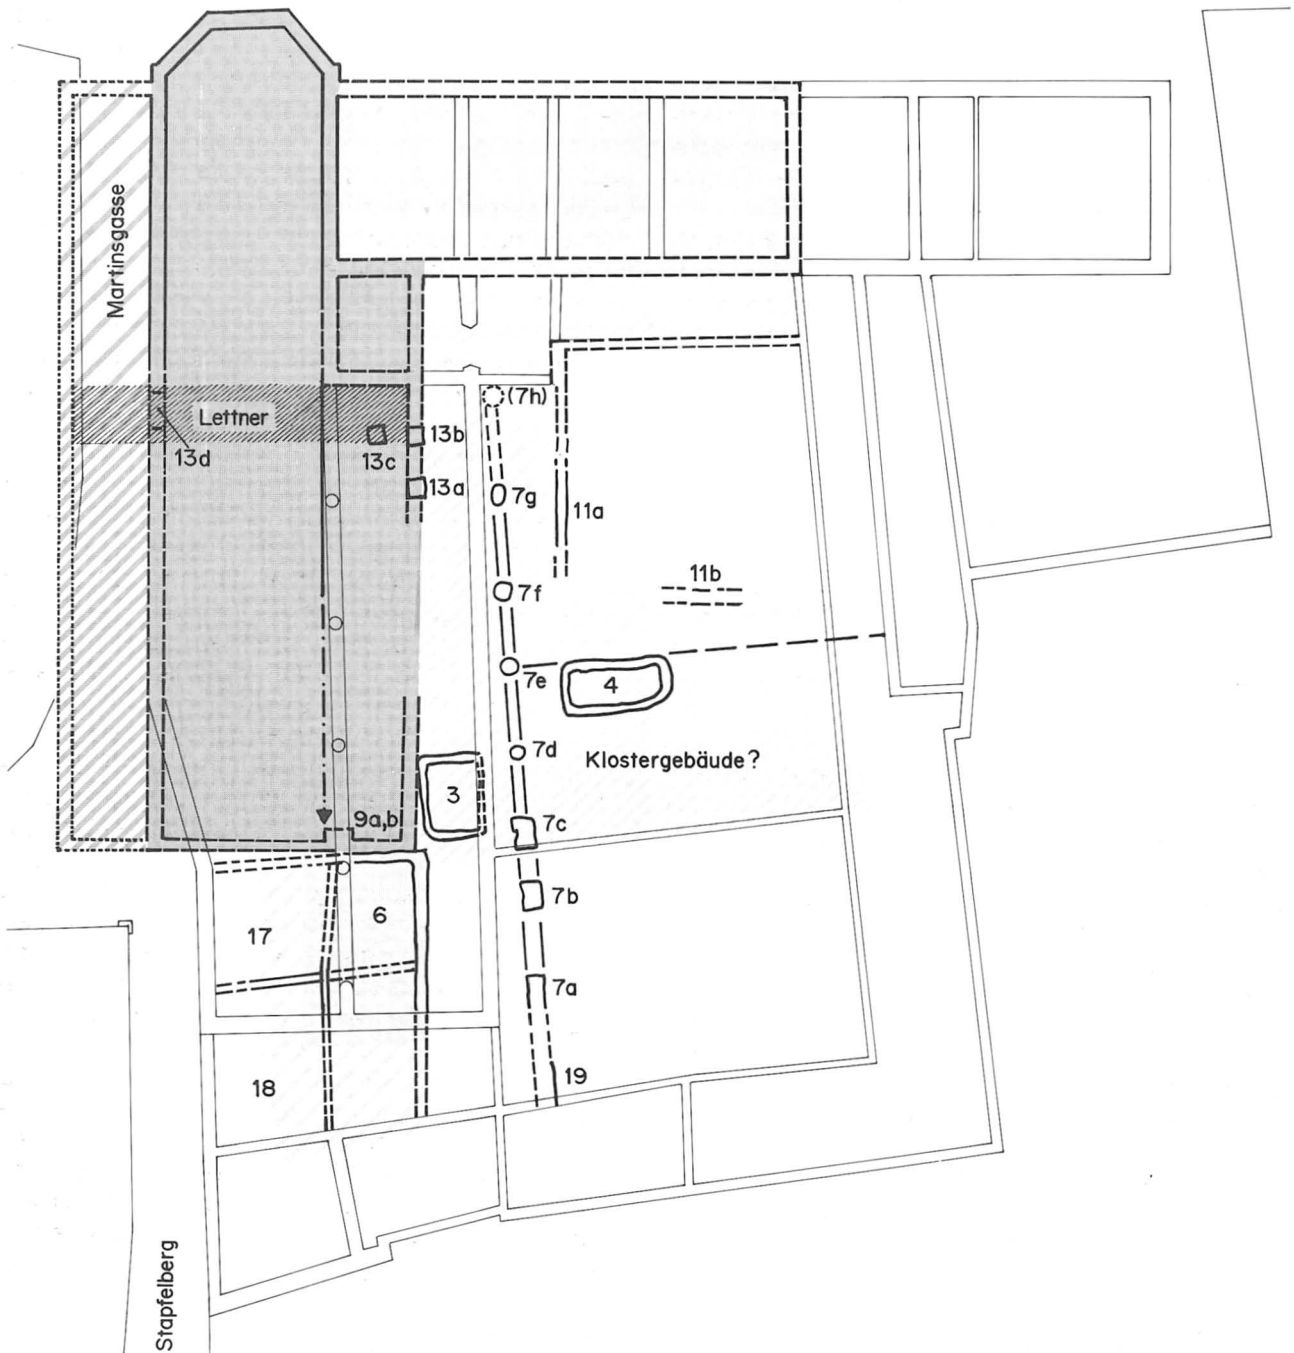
Grundriss des Klosters um 1280/90 (Kirche Ia). Rekonstruktion. Die Schraffuren deuten Wahrscheinlichkeitsgrade an. – Massstab 1:400.
